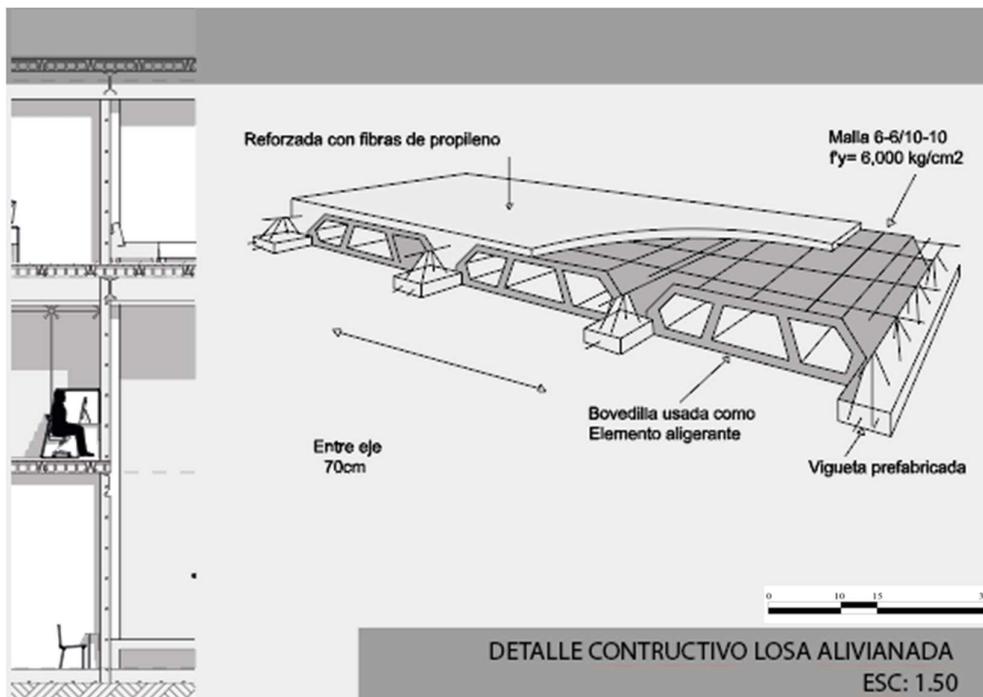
Detalle constructivo losa alivianada Elaboración propia
